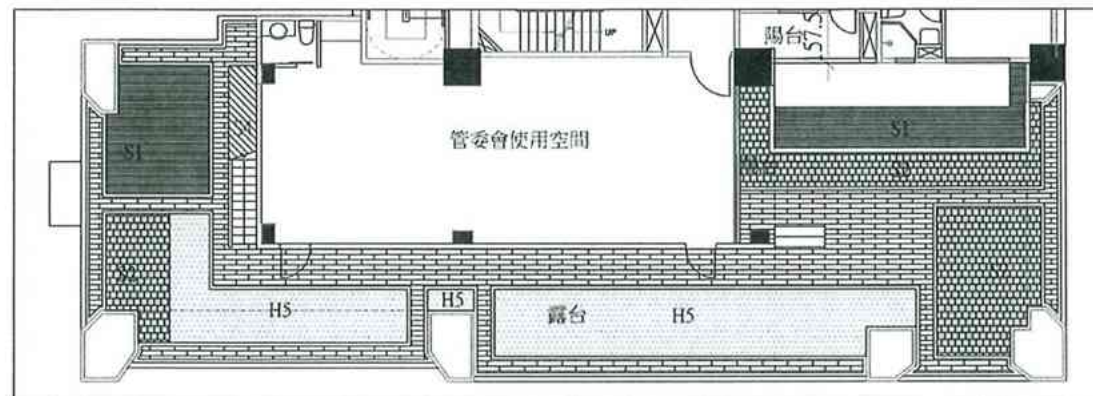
平面植栽(灌木)配置圖(1/200)
